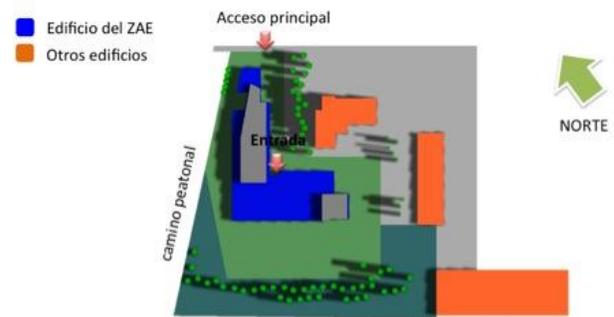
Planta de conjunto del proyecto propuesto para el ZAE. Fuente: Elaboración Propia
